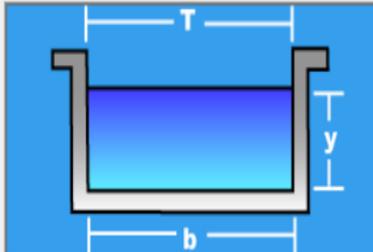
Diseño de alcantarilla de paso N°2, tipo cajon.
